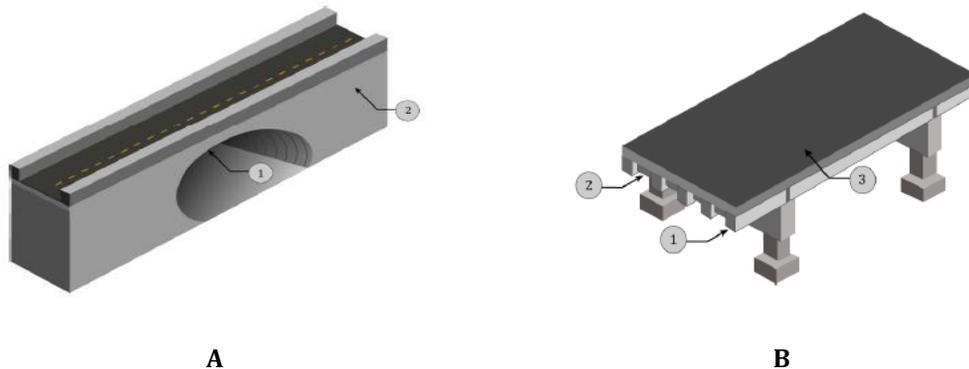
Elementos en orden jerárquico de importancia según clasificación del MOP según tipo de puente (esquemas tomados de manual propuesto para inspecciones de puentes). A: Puente de tipo Súper span, B: Puente de vigas con tramos isostáticos.
